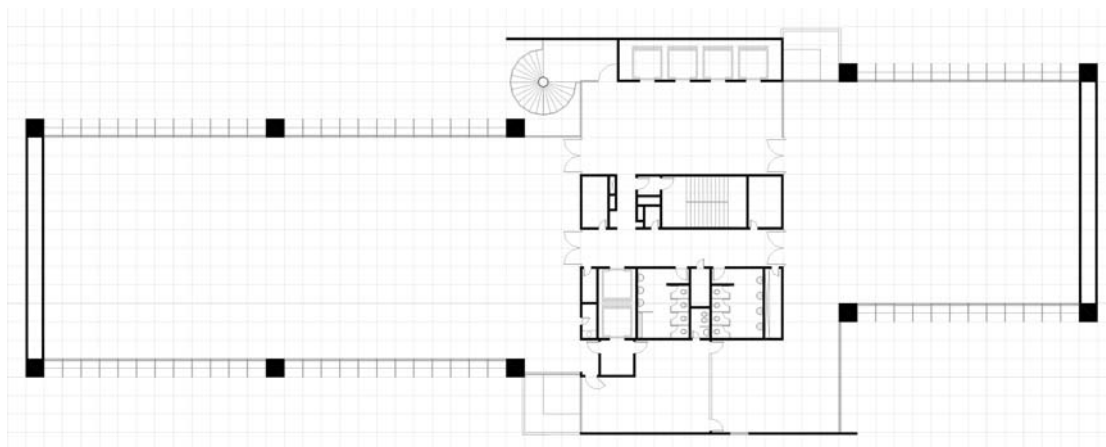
Planta de Situação Sede Ministério da Fazenda de Fortaleza (1975)
